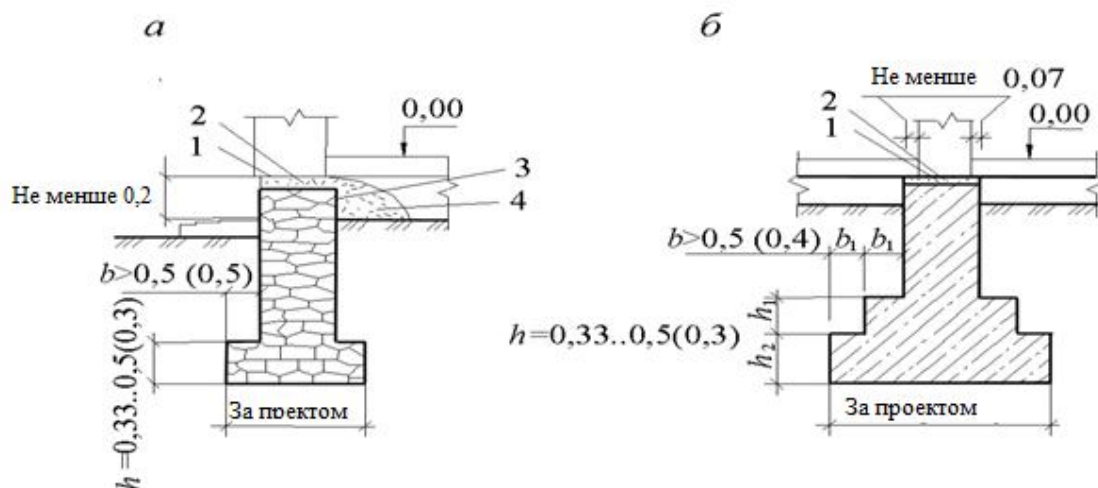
Бутові та бутобетонні фундаменти з уступами:
